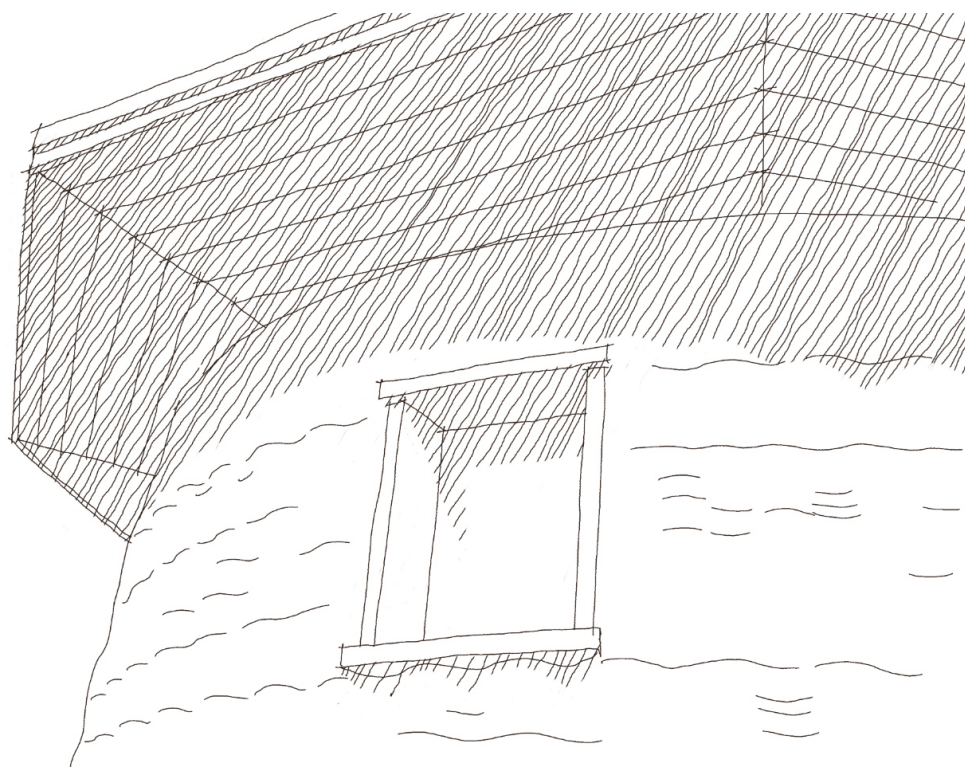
Detail půdorysného řezu zdi (3D Wasp 2020)
